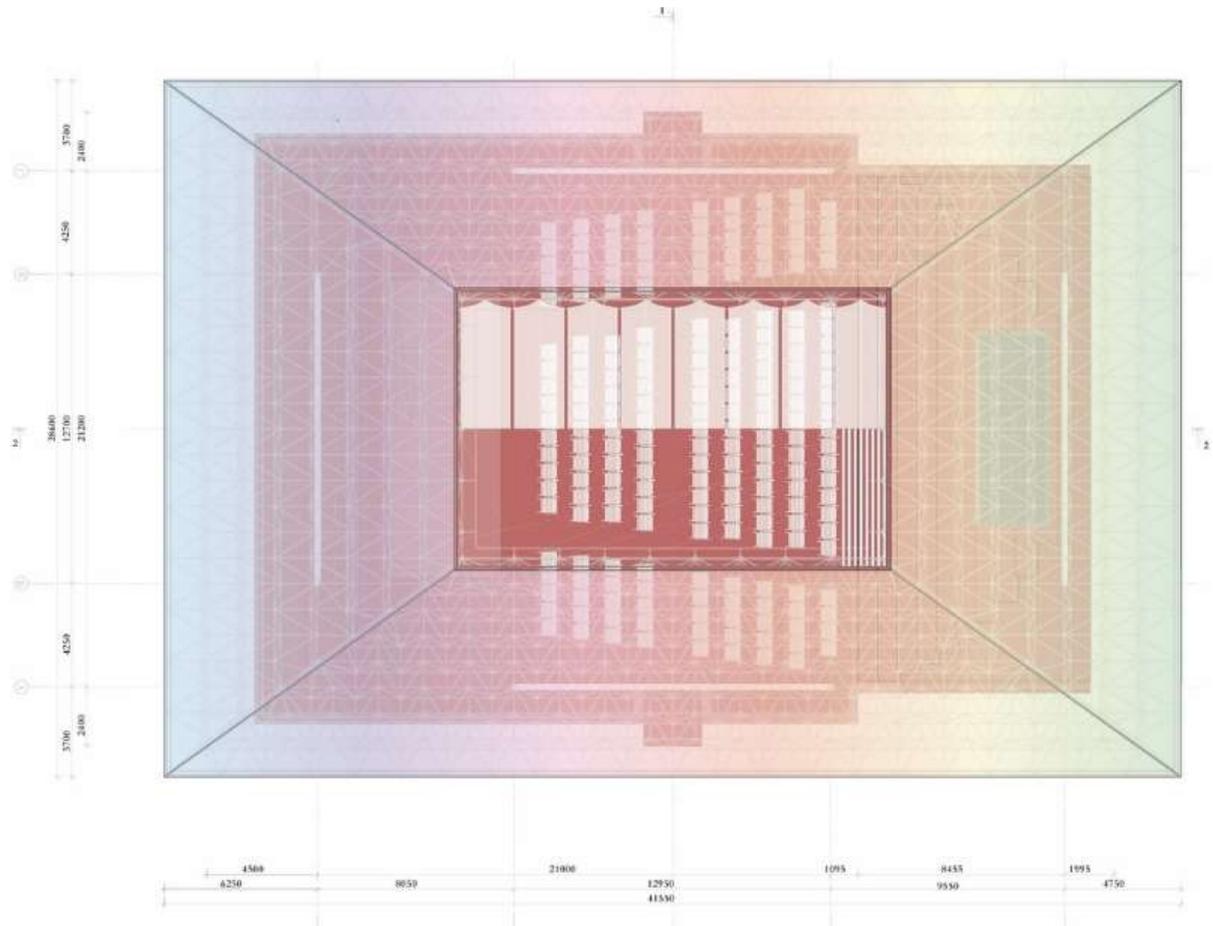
PLANTA LAYOUT CINEMA GARAGE SCREEN
